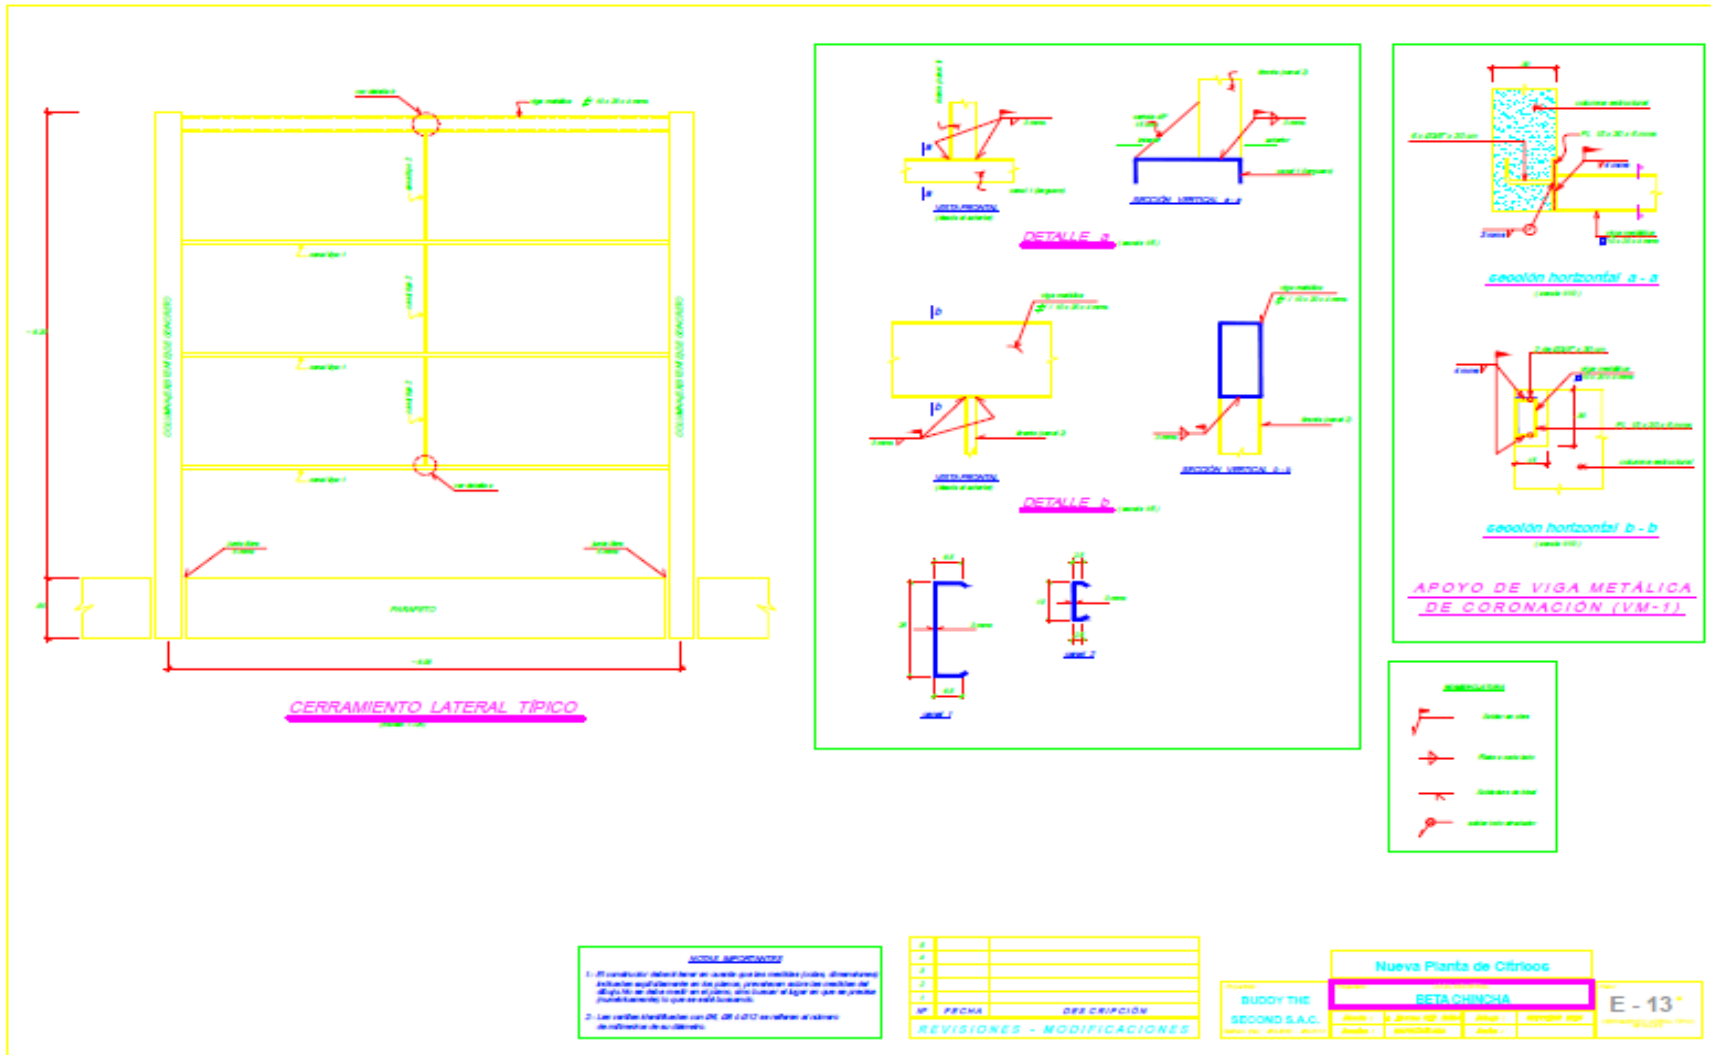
Plano de Cerramiento Lateral Típico, detalles.
